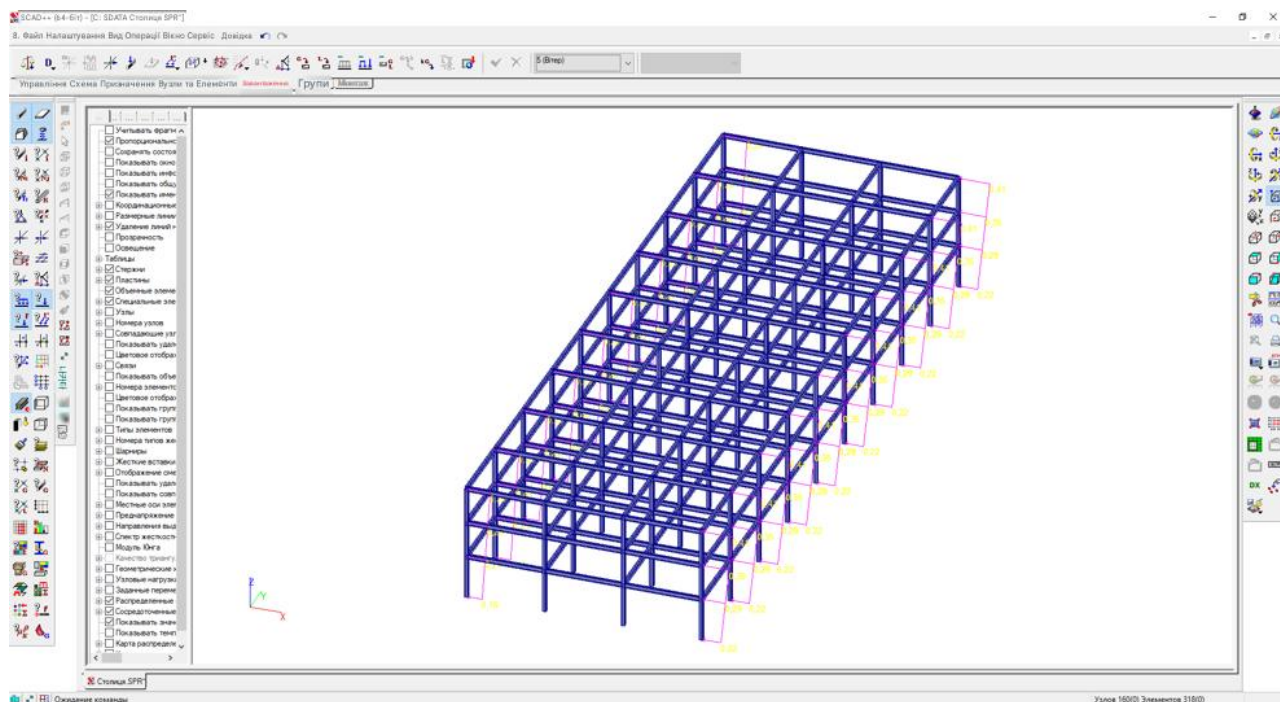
Просторова розрахункова схема будівлі з прикладеним вітровим навантаженням справа
